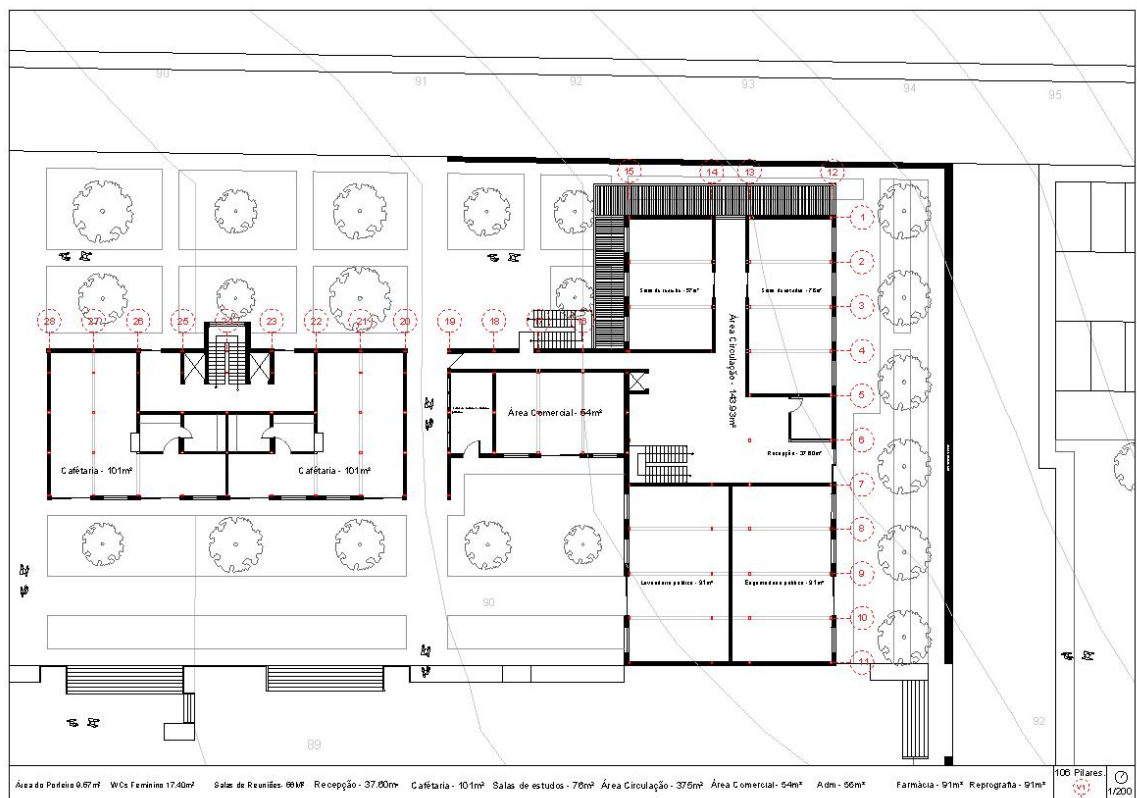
Planta do Térreo 4 Bloco 1/200.
